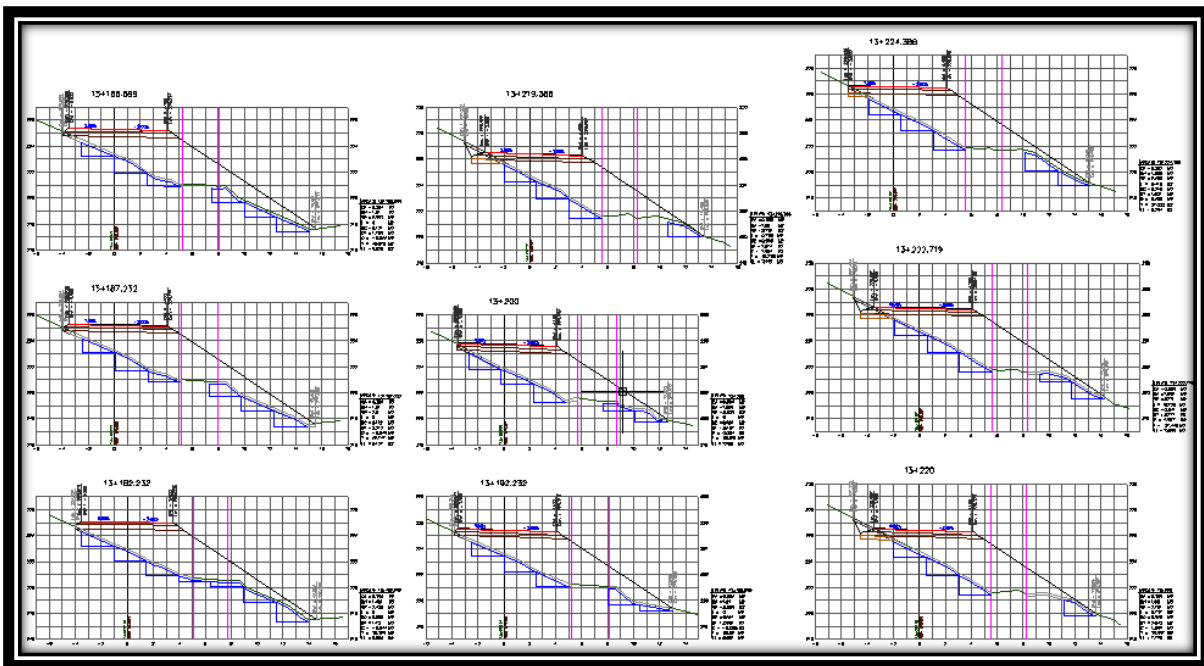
Secciones de construcción del km 13+182.232 al km 13+224.386.
